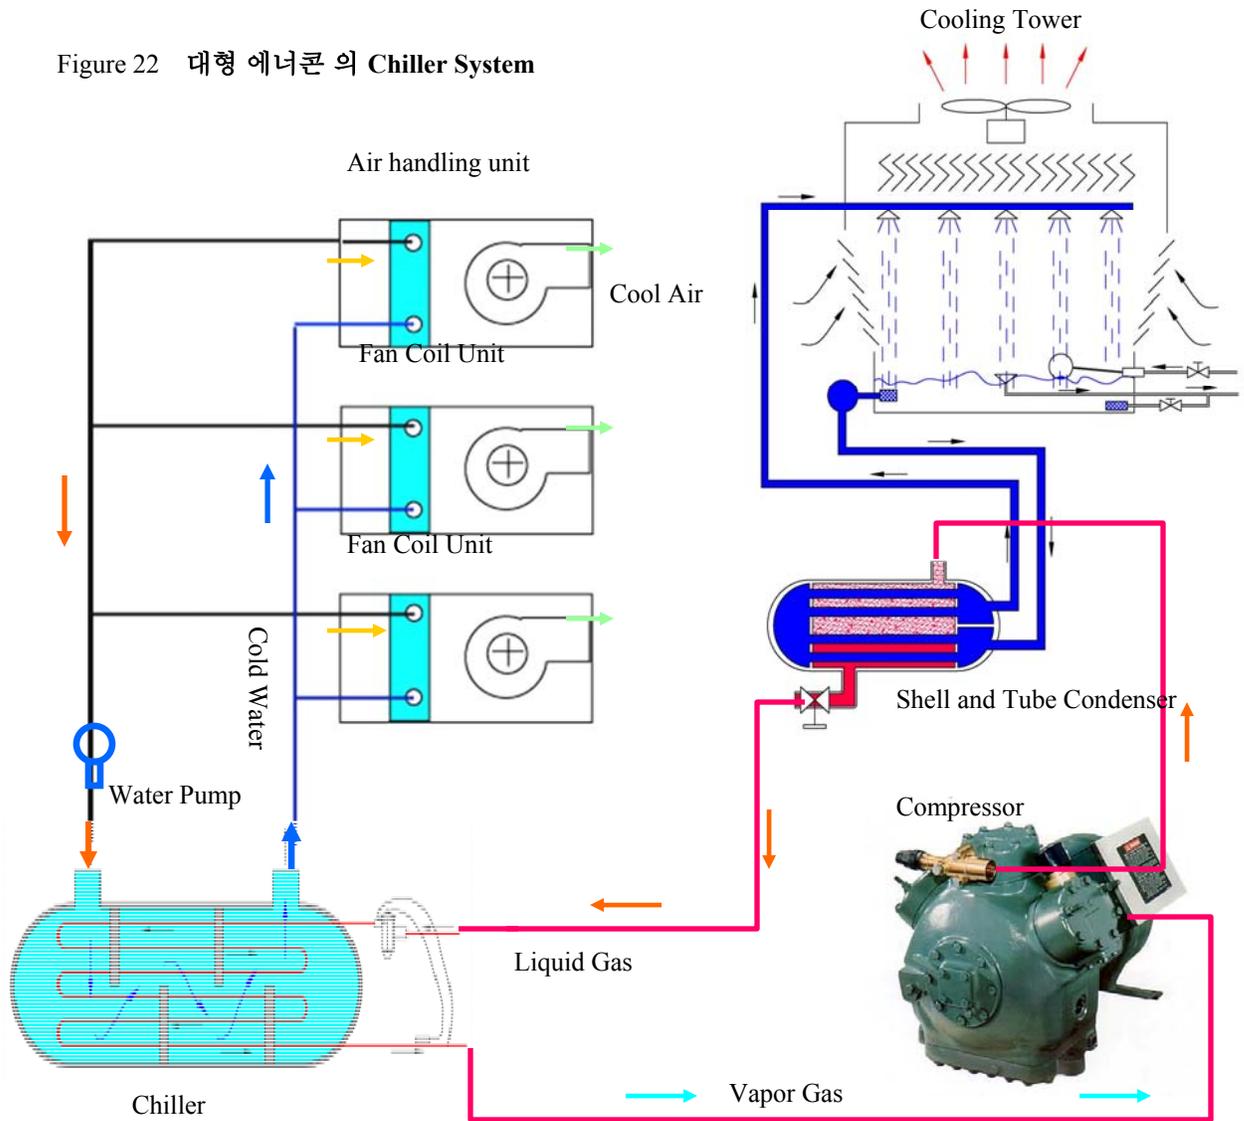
와 Figure 21을 조합하여 대형 에어컨 Chiller 시스템 계통도를 작성한 것이 위의 그림이다. Compressor 를 병렬로 여러대 놓으면 Chiller의 용량도 더 커지고 실내에 있는 Air Handling Unit와 Fan Coil Unit들도 더 많이 설치할수 있다.
